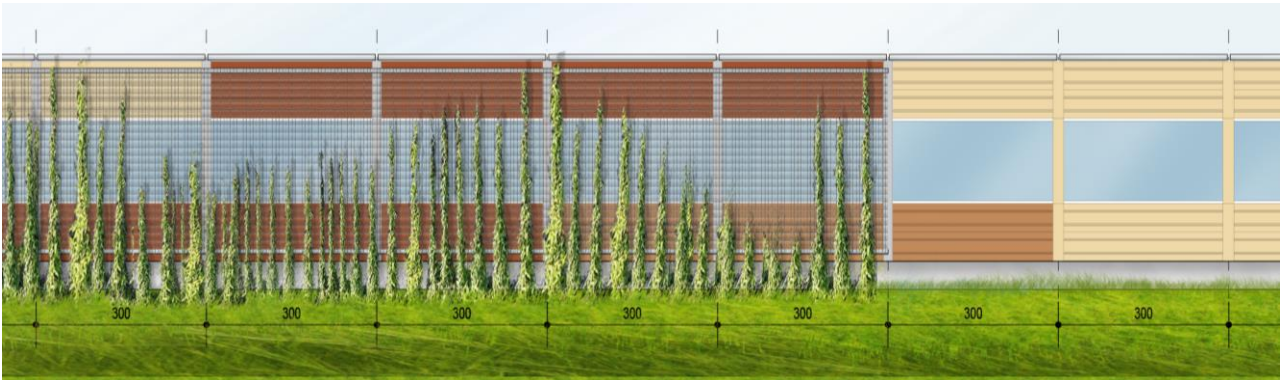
BARRIERA ACUSTICA MISTA FONOASSORBENTE-FONOSOLANTE – PROSPETTO LATO RICETTORE
